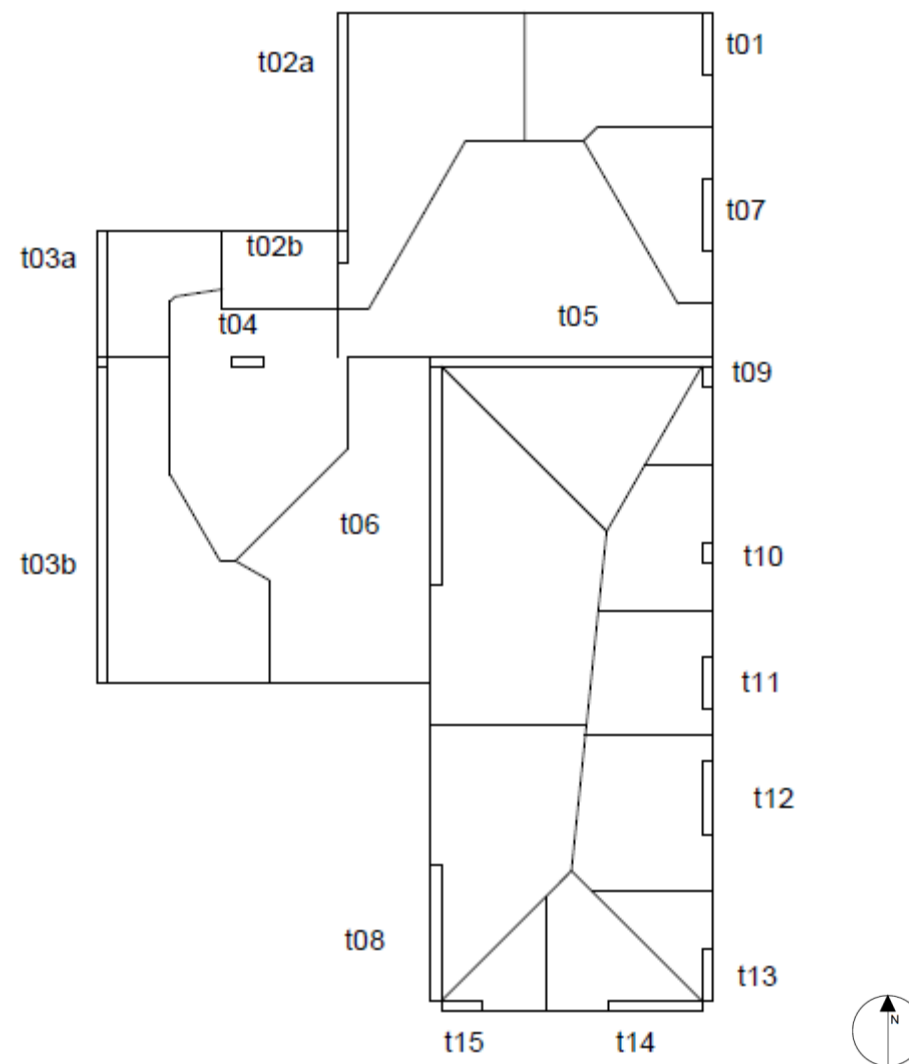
Área de influência de bloco para laje 1 Pavimento
